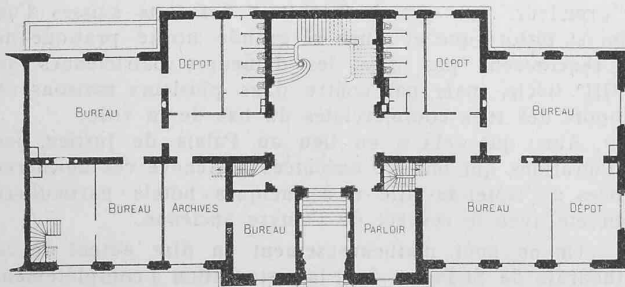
Plan du Rez-de-Chaussée. — Echelle 1 : 500.
